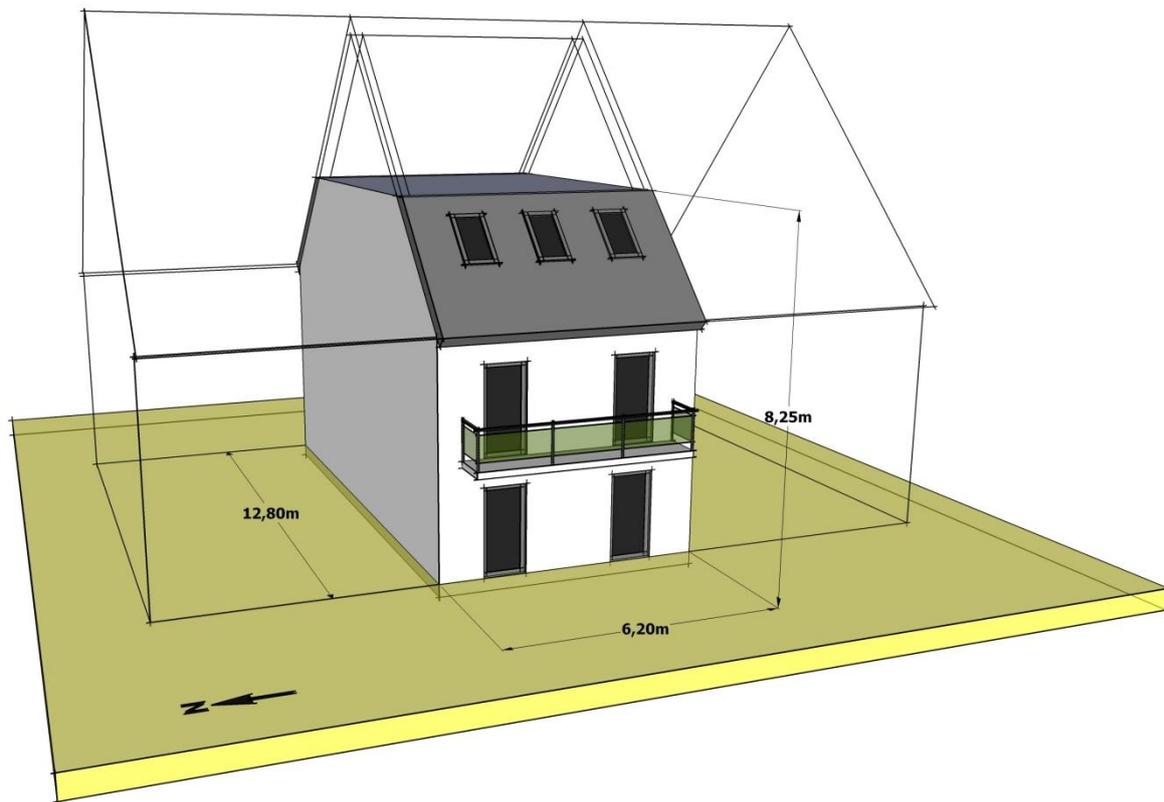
Reihenmittelhaus – Ansicht Nord-West
